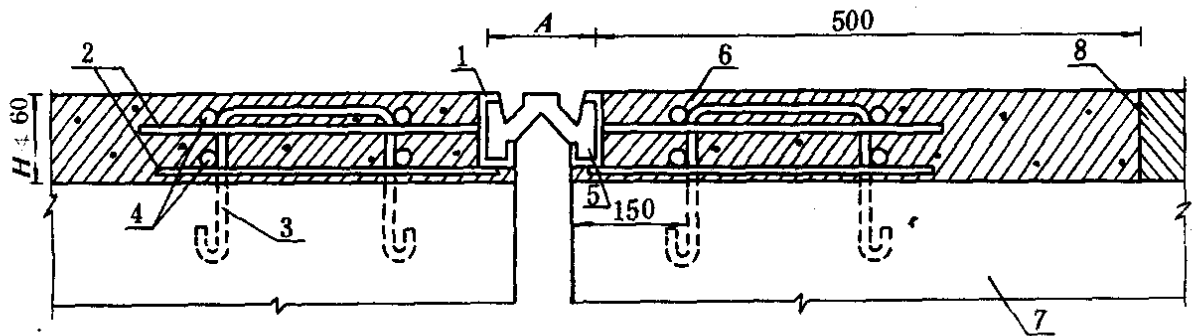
W 型伸缩装置横断面图 (尺寸单位: mm)
